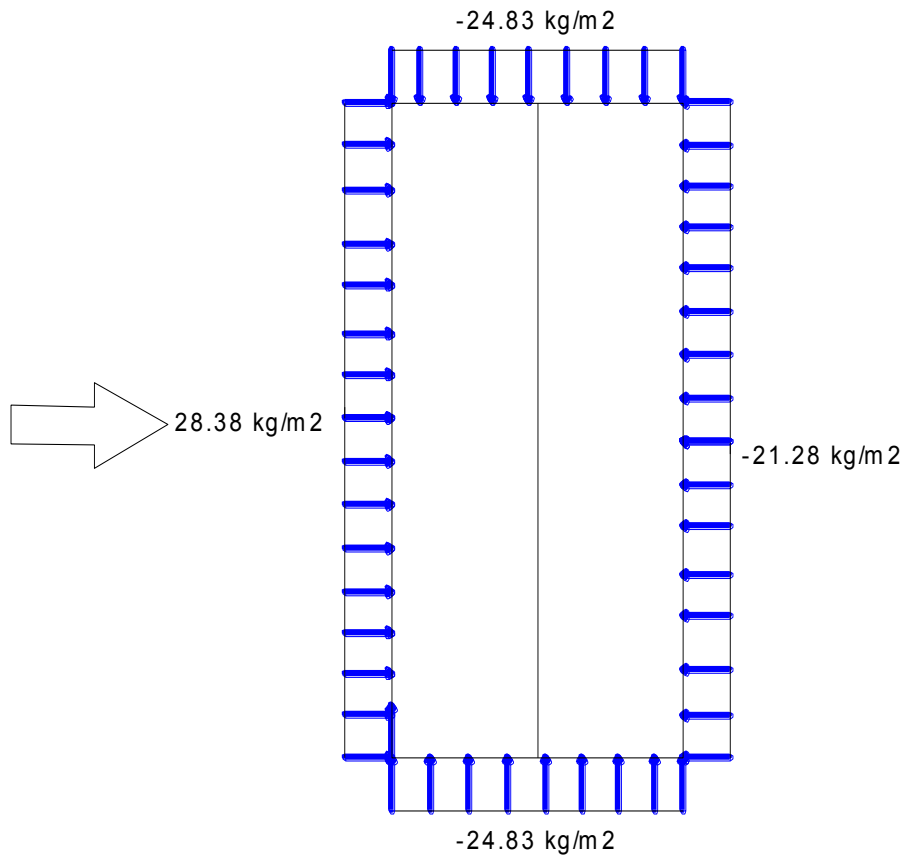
Segundo caso W_x1 : viento paralelo los pórticos (techo inclinado menor a 15°) planta. Fuente elaboración propia.
